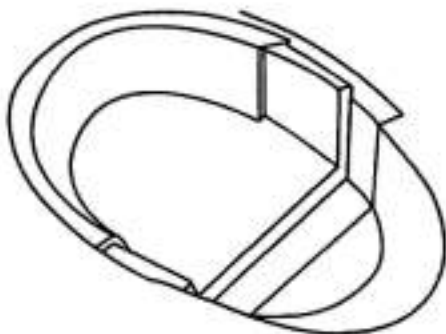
Устройство пруда с гидроизоляцией из бетона
